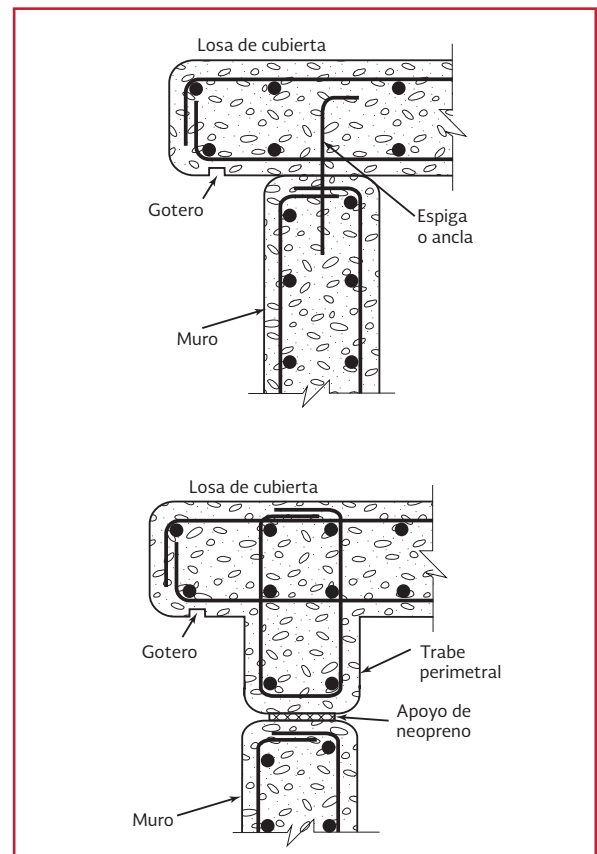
Ejemplo de tanque de concreto con cubierta
